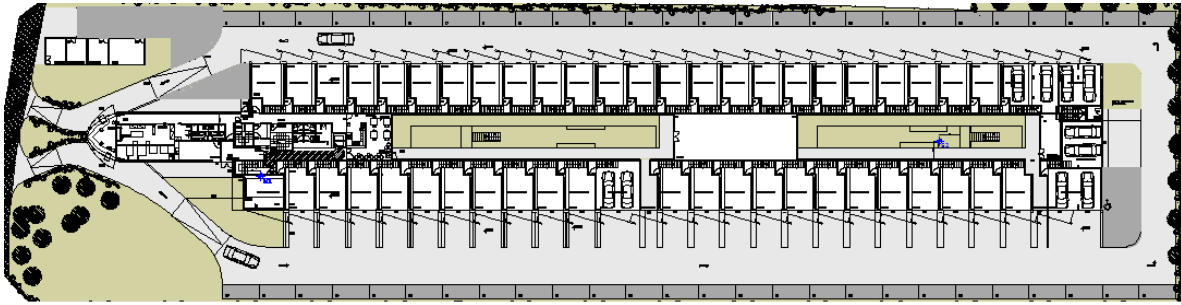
PLANTA DO EDIFÍCIO EM CAUSA [51].
